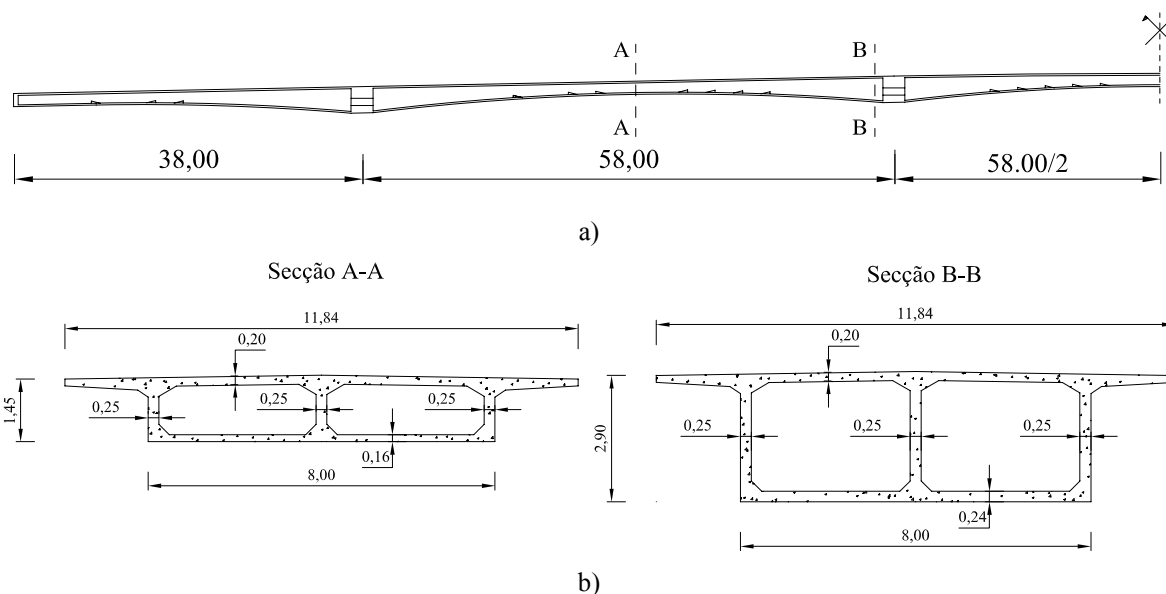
Geometria da ponte: a) corte longitudinal do tabuleiro; b) secções transversais tipo.
